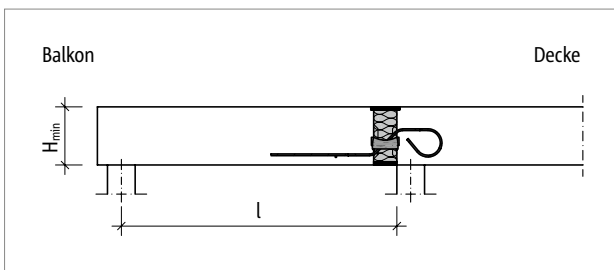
Schöck Isokorb® T Typ QL-V1: Statisches System
